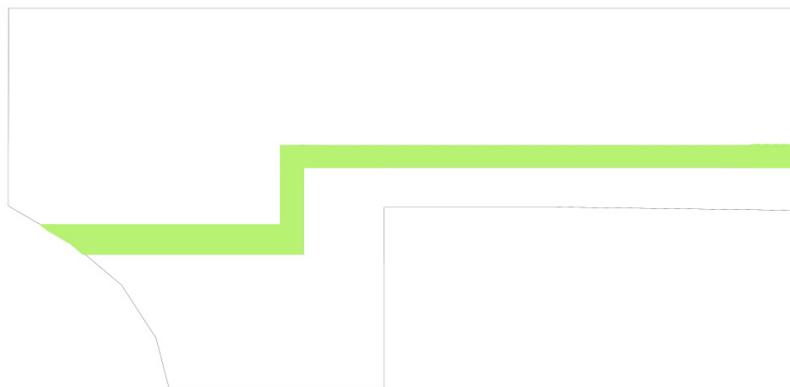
Planta con eje peatonal marcado. (Elaboración Propia)
